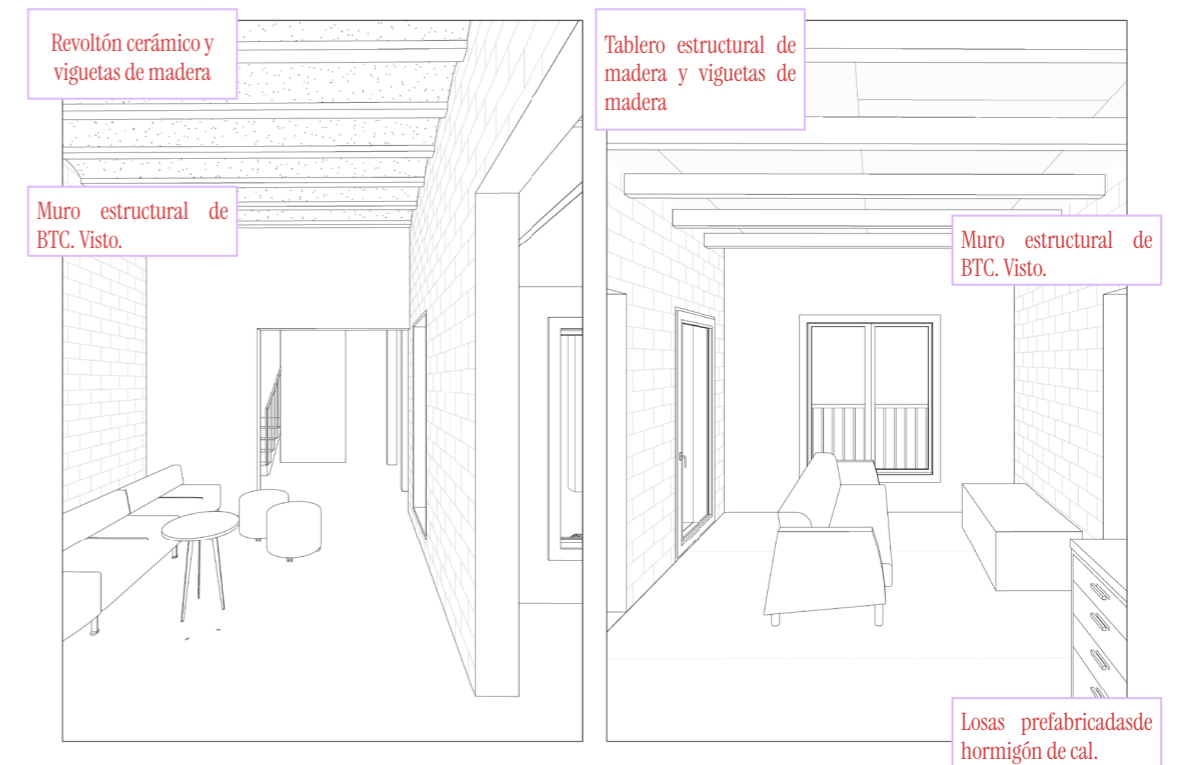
Izq: vista interior zaguán. Dcha: vista interior vivienda. Elaboración propia.
